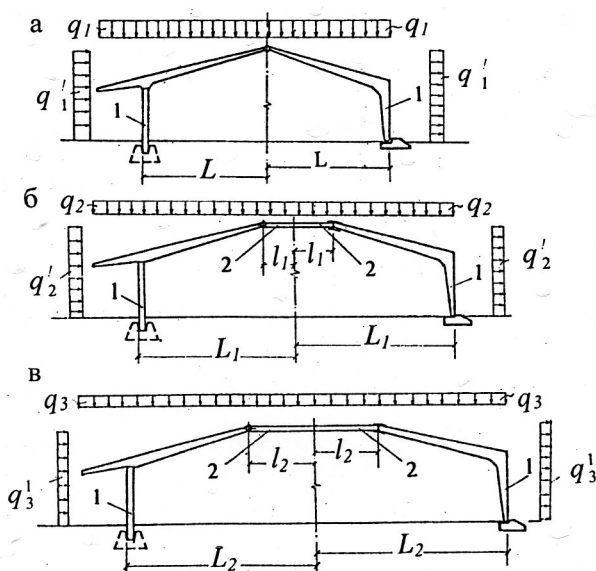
схемы поперечных разрезов каркасов
